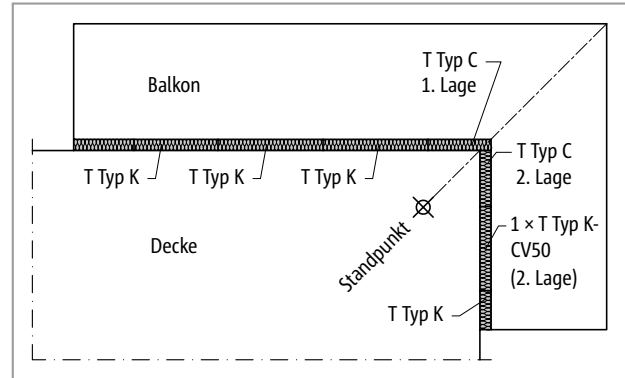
Schöck Isokorb® T Typ C: Balkon mit Außenecke frei auskragend
